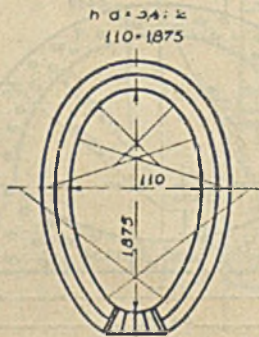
Przekrój eliptyczny ze żłobem i chodnikami (Paryż).
